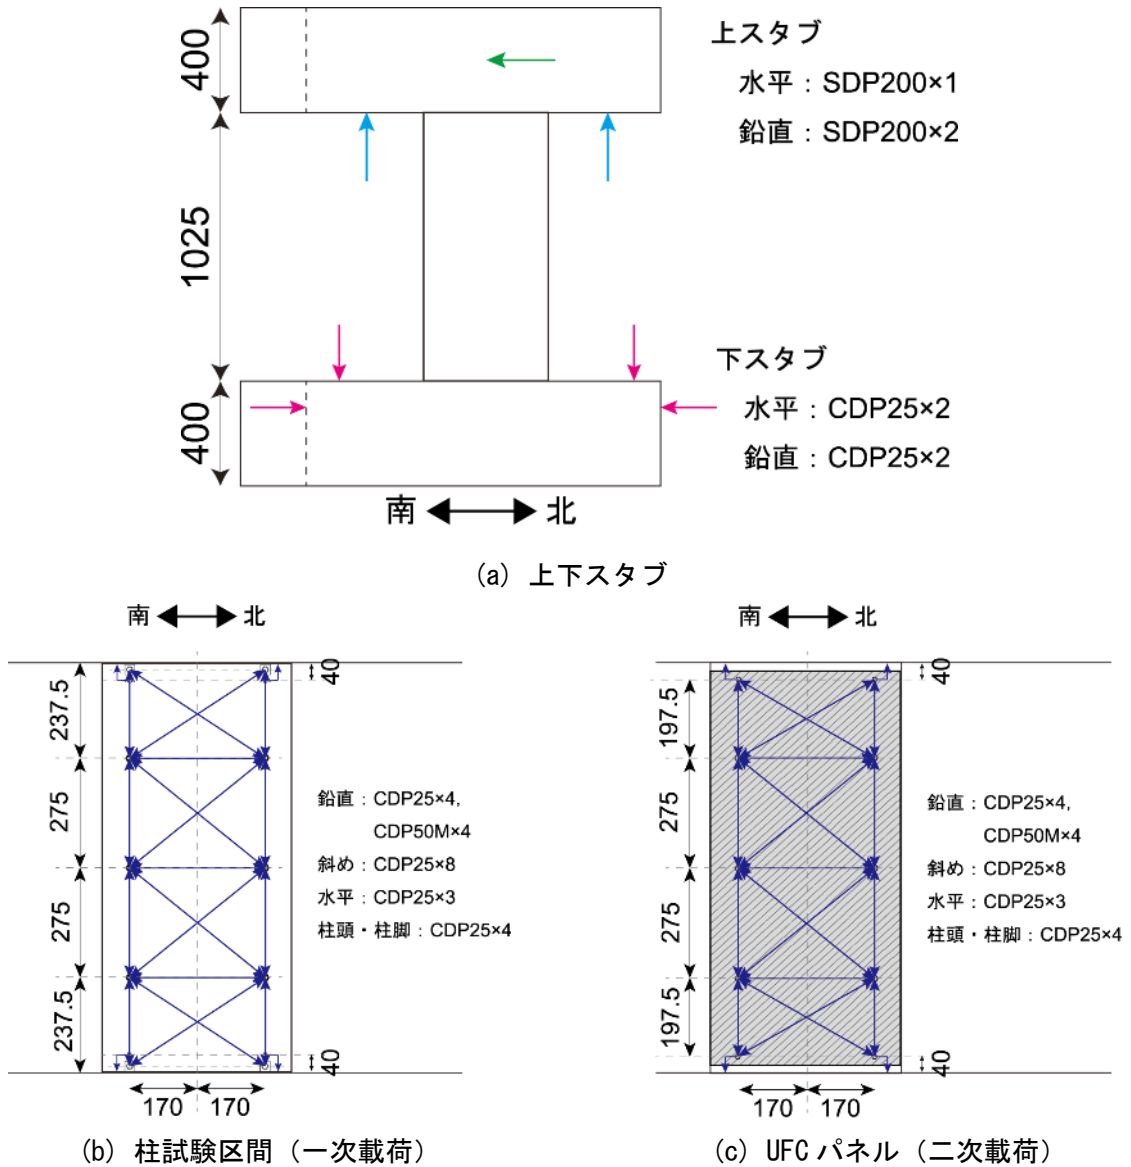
変位計取り付け位置図 (東面図) (単位 : mm)
